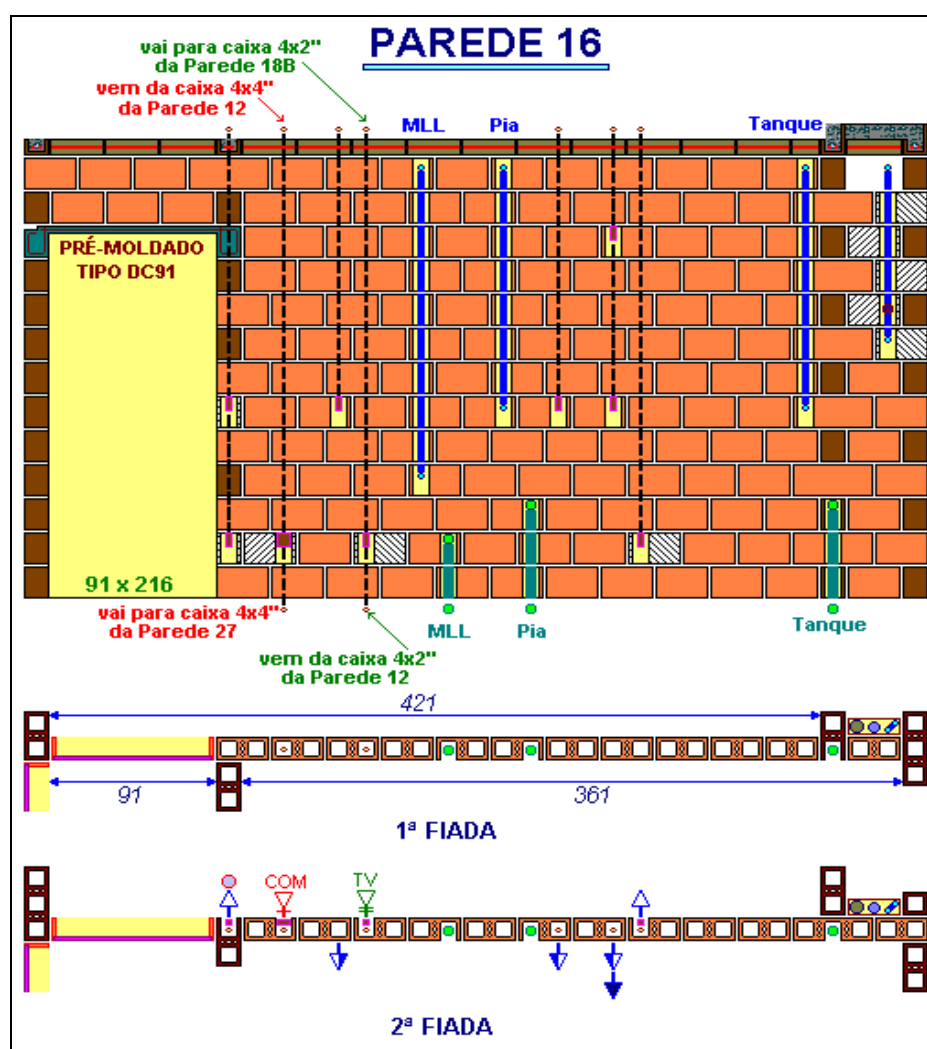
Exemplo de projeto de elevação de parede em alvenaria estrutural, contendo o projeto elétrico.
